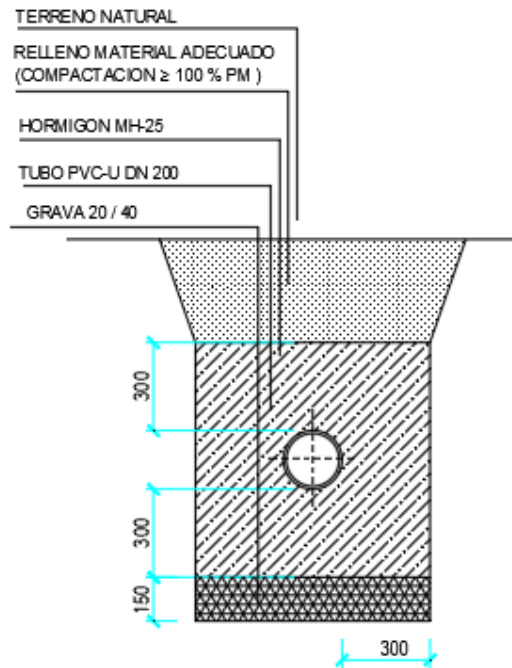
Sección constructiva colector PVC. Fuente: Elaboración propia.
